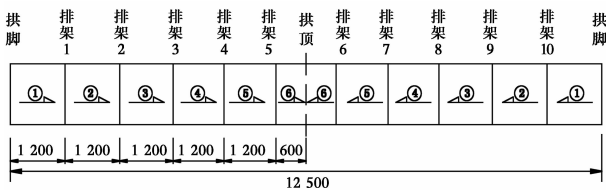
第 3 环混凝土浇筑节段平面图(单位:cm)
